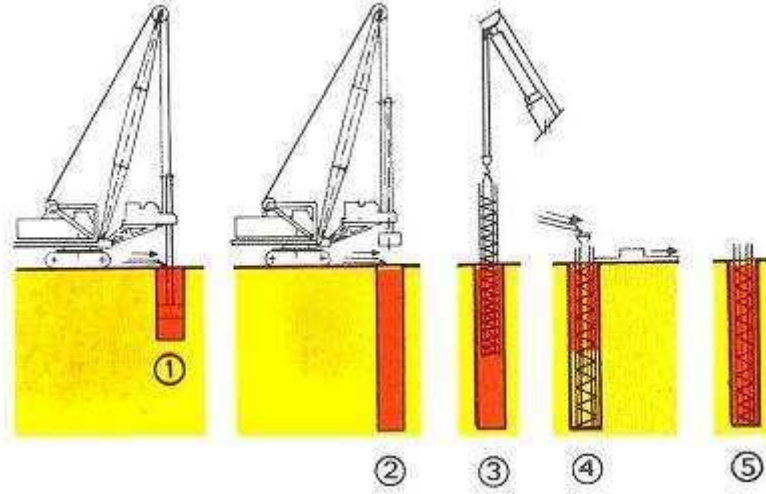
Jet grouting kolonu imalatı aşamaları
